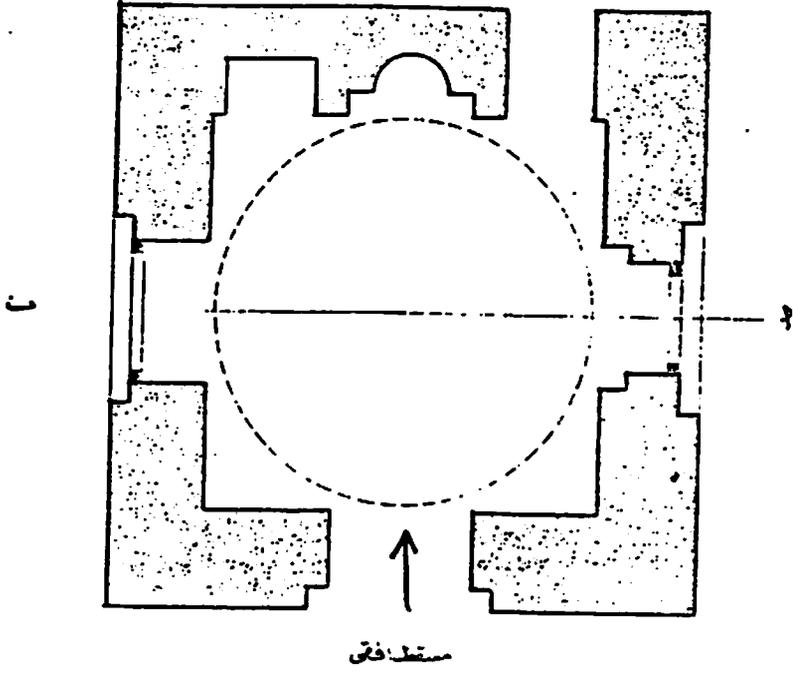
مسقط أفقى لقبة الرفاعى عن هيئة الآثار
